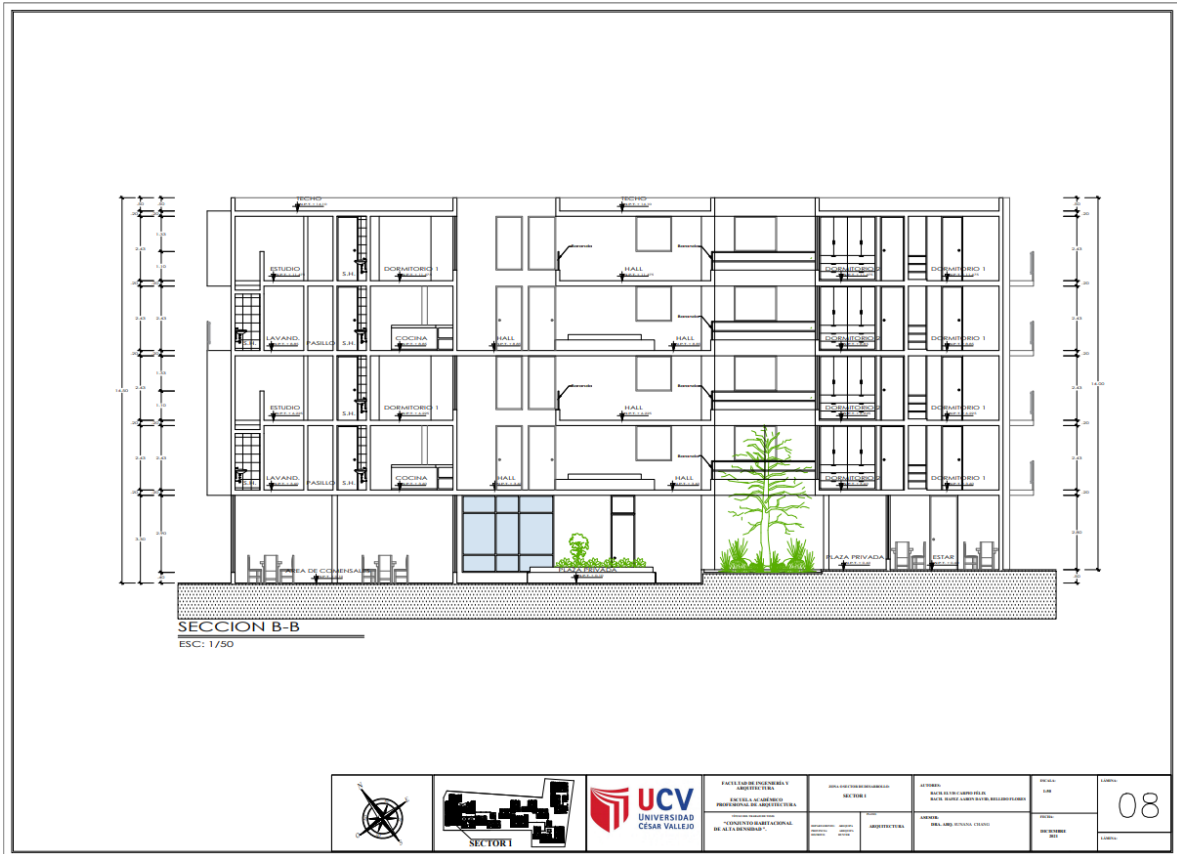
Planos de Arquitectura – 08 - Bloque 1 – Cortes – Sección B-B
